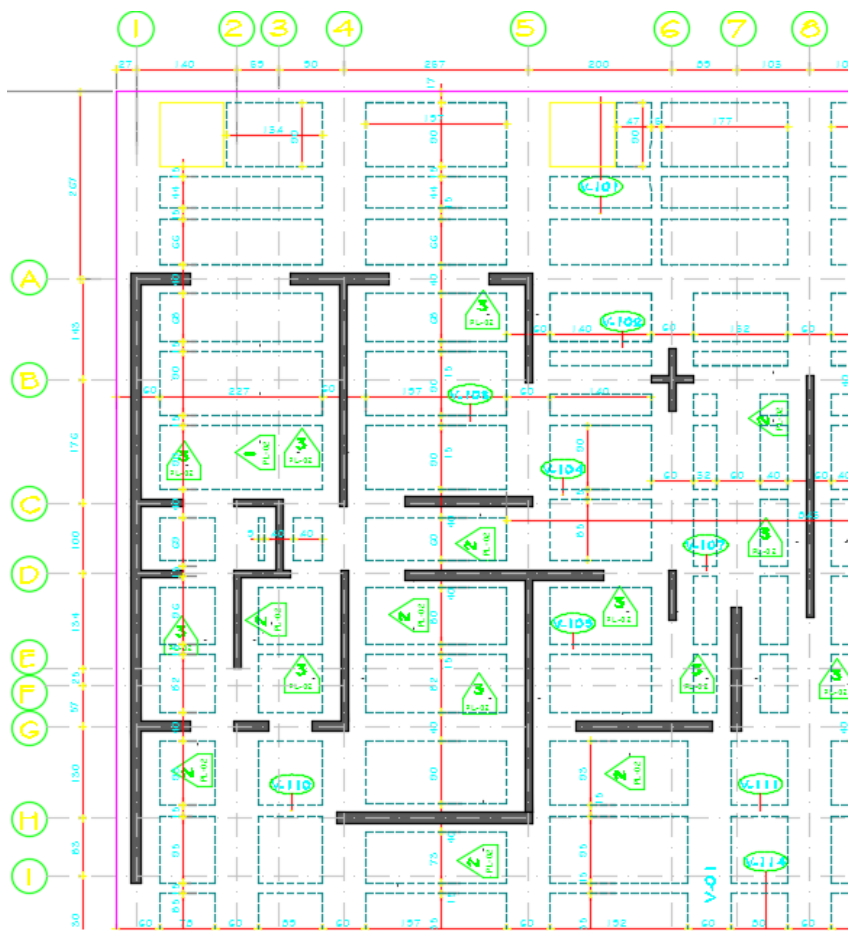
Plano de cimentación, acercamiento de un apartamento.
